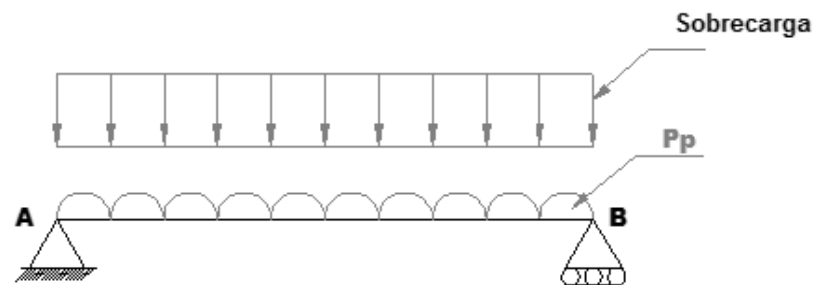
Elemento horizontales sometidos a cargas distribuidas y condiciones de apoyo simple.
